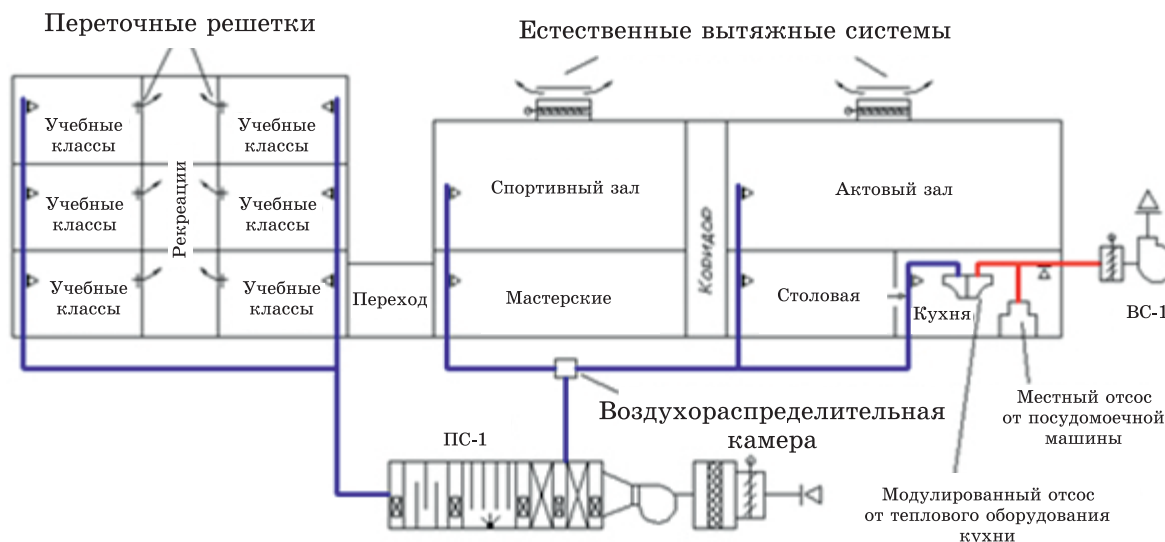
Принципиальная схема систем вентиляции и воздушного отопления школы по типовому проекту 65-426/1
